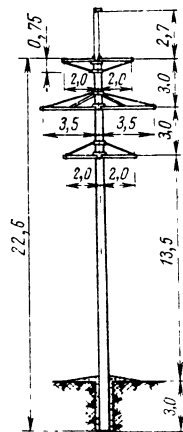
Железобетонная промежуточная двухцепная опора ВЛ 110 кВ
